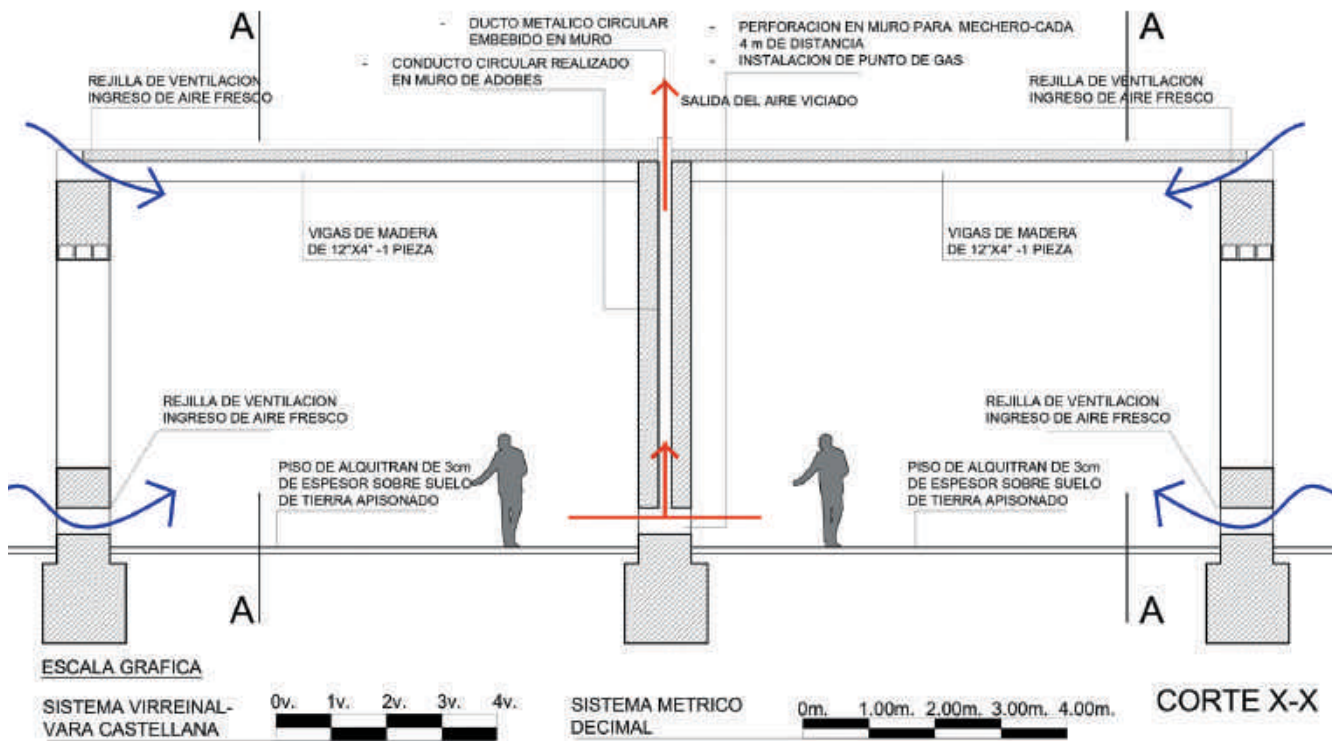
Corte de las Salas de enfermería donde se demuestra el sistema de ventilación propuesto por Mateo Graziani para las enfermerías
